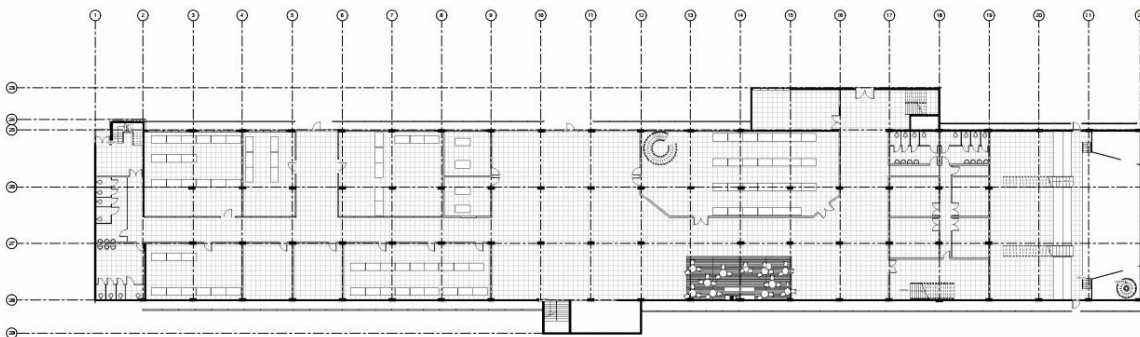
Planta nivel 1, donde se ven los ejes donde están ubicados los elementos estructurales (2021)
